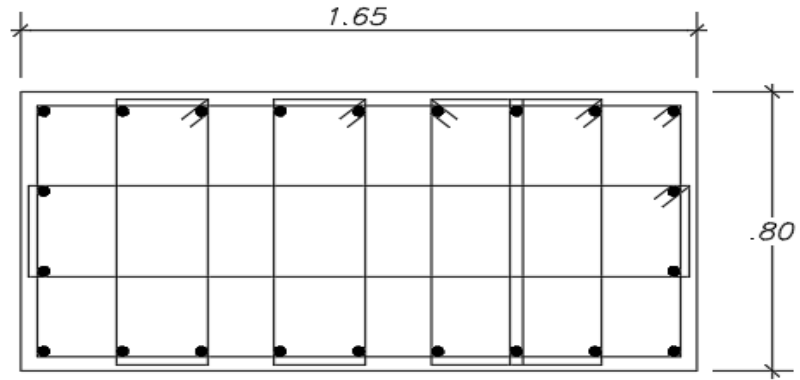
Columna C5 (1.65x0.80) 2° piso
